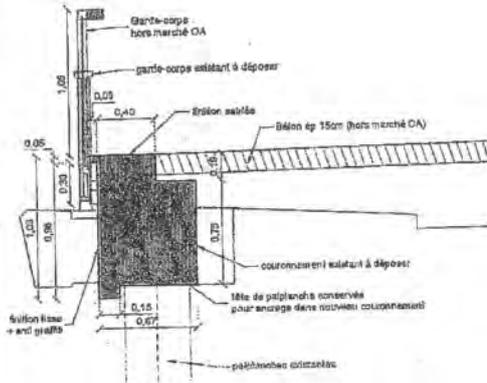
APPUI ET RIVE COTE VILLE
